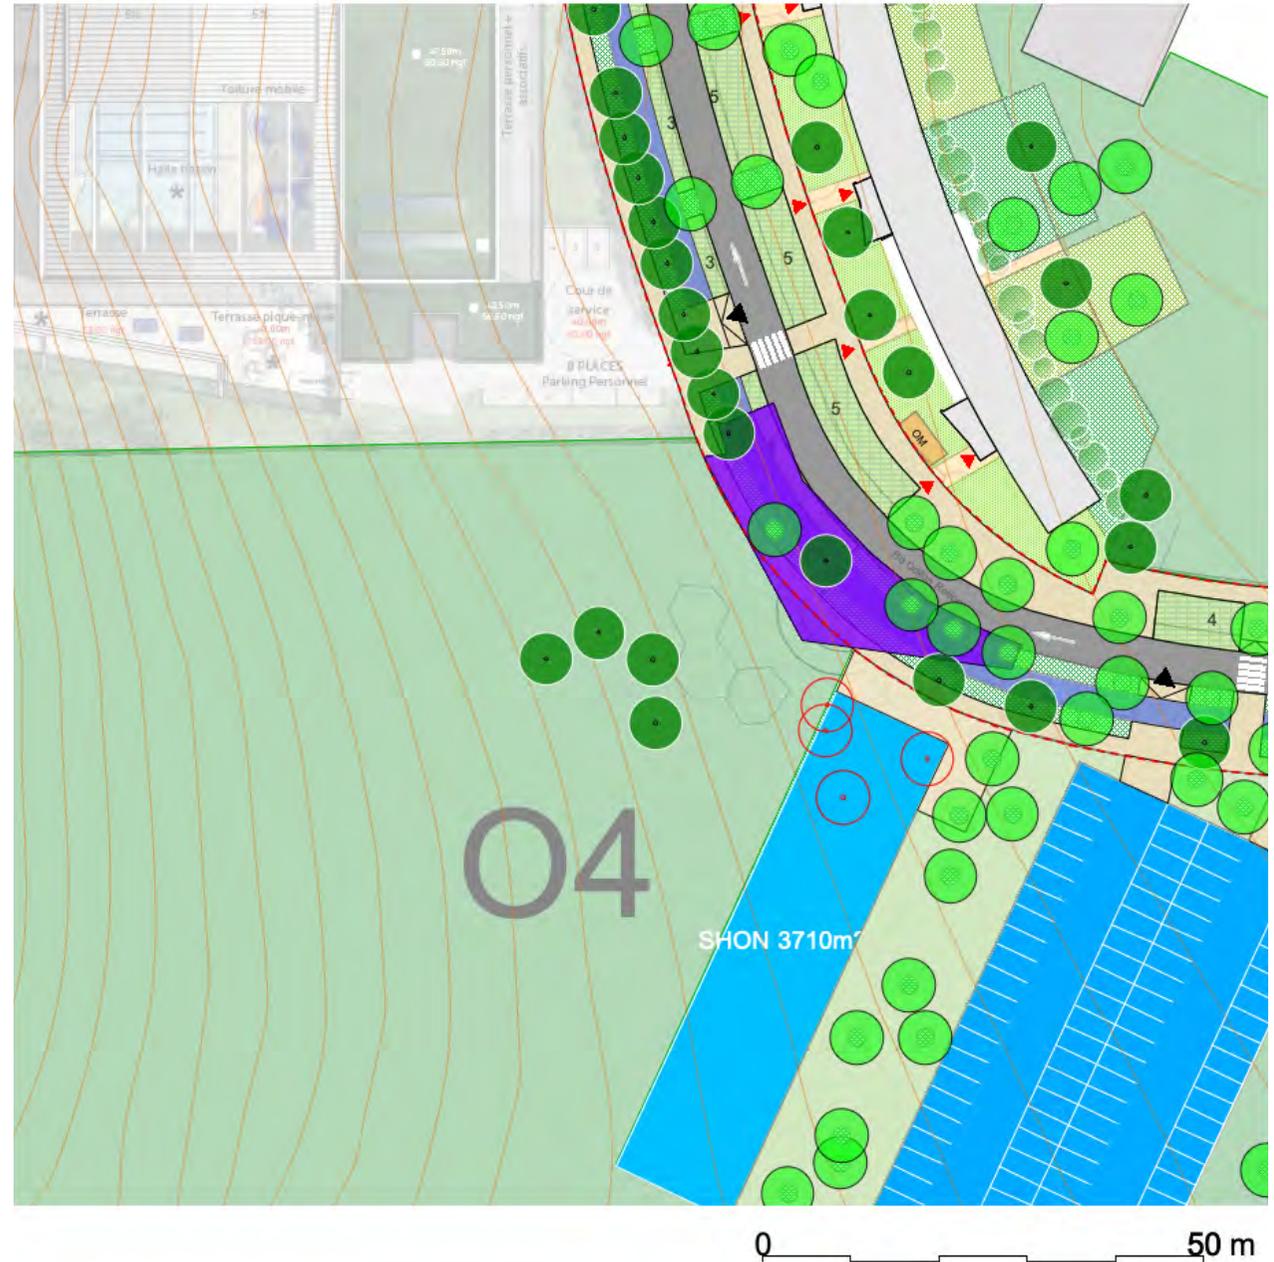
BOULEVARD ODILON REDON PROJET DANS LE PLAN GUIDE
